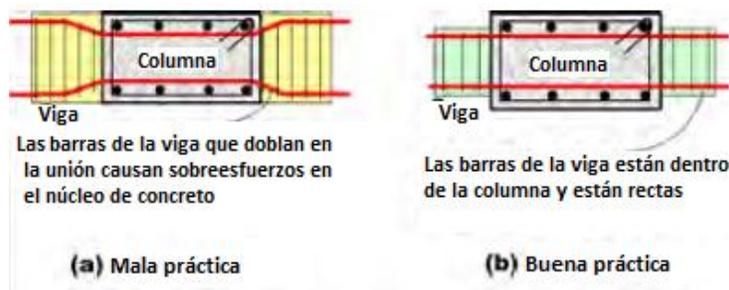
Detallado del refuerzo en la unión que muestra la importancia de colocar el acero de refuerzo horizontal de la viga dentro de la armadura de la columna (fuente: Murty 2005).
